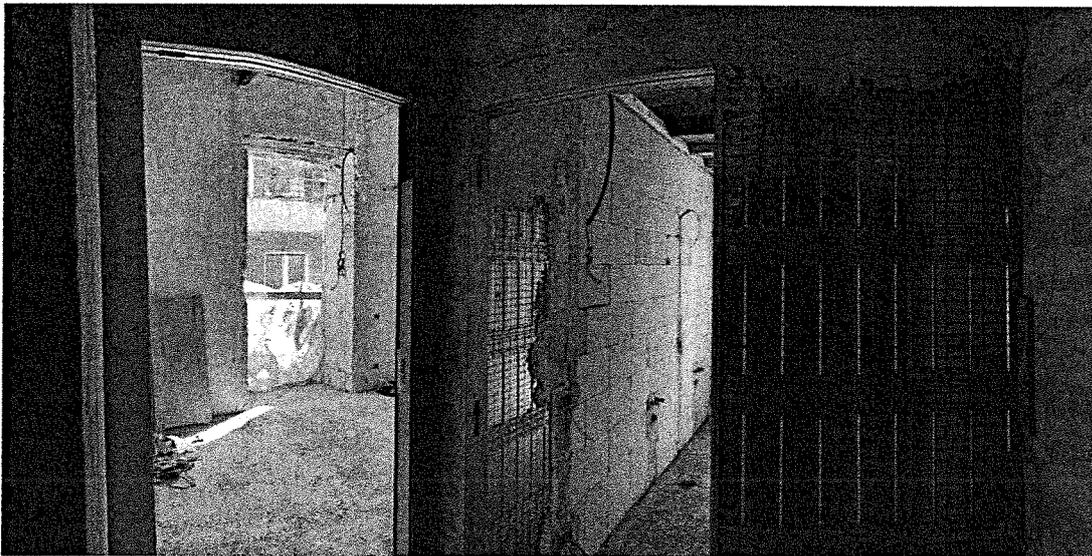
Il bagno B2 ed il locale L3 dal disimpegno
